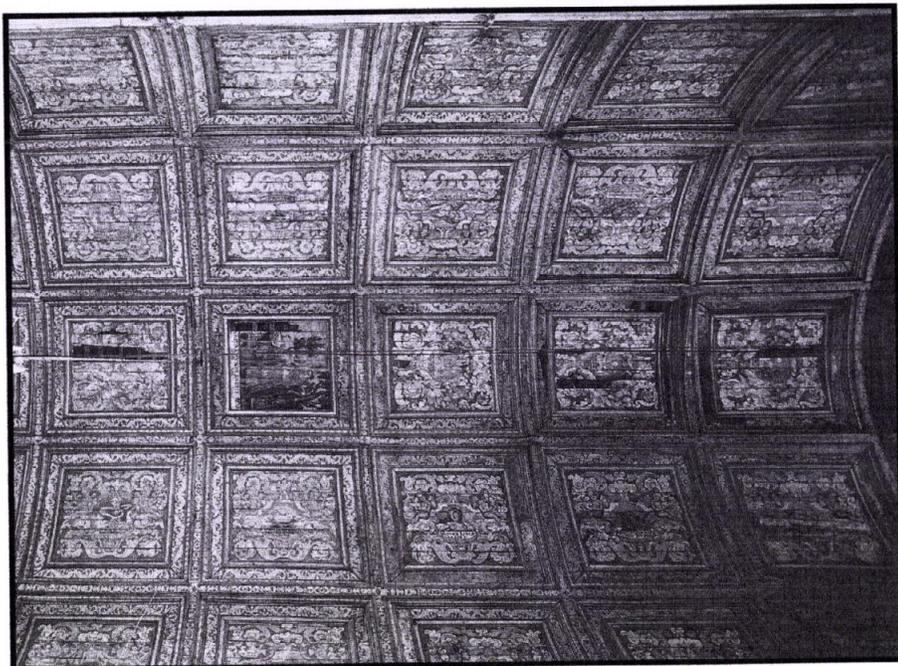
Tecto apainelado (década de 1950). DGEMN.
